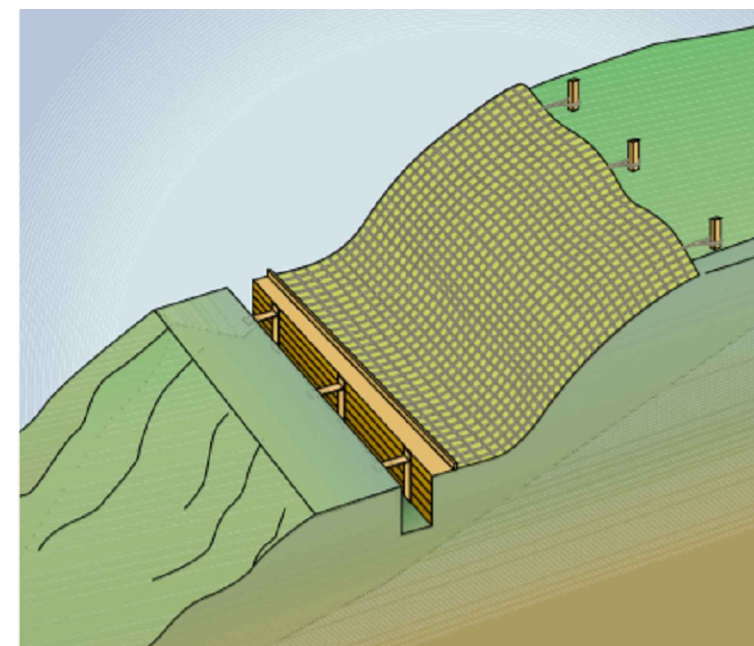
Escavação mista – com paredes em taludes e com paredes protegidas por cortinas
